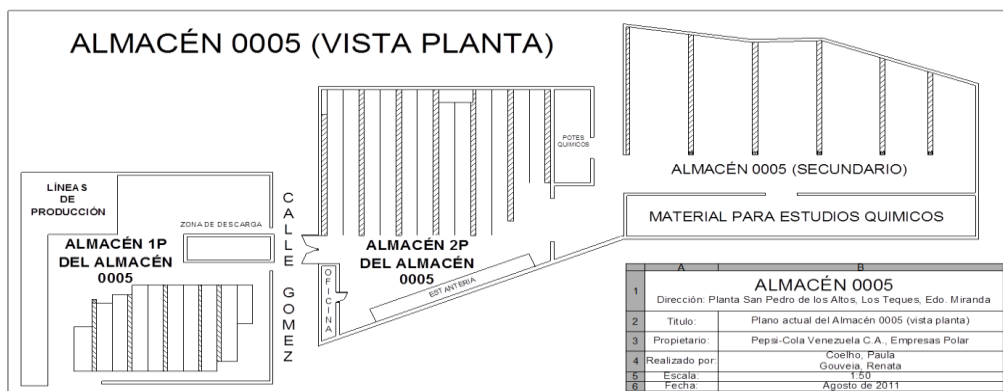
Plano Almacén 0005 (Vista Planta)
